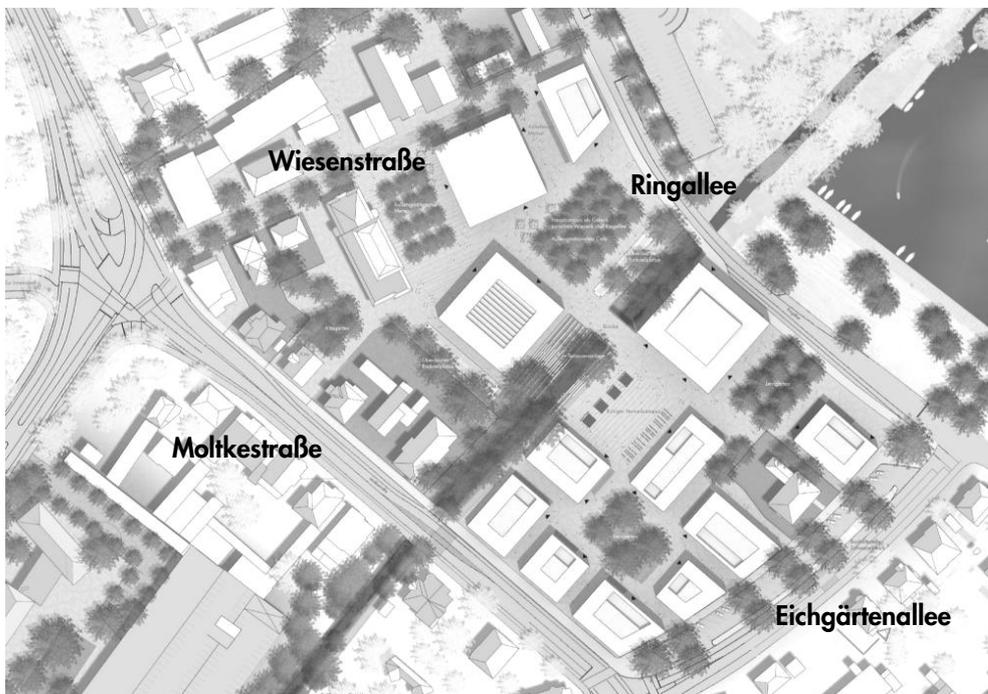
Lageplanausschnitt zum Campus Wiesenstraße aus der Masterplanung (schneider + schumacher 01.12.2011)
